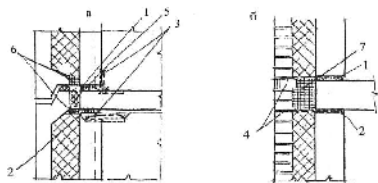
Схемы связей несущих наружных стен с несущими внутренними конструкциями и теплоизоляция зон сопряжений слоистых наружных стен с внутренними несущими конструкциями: а – в панельных стенах; б – в комбинированных (монолитно – кирпичных). 1 – цементный раствор; 2 – упругая прокладка; 3 – сварные стальные связи; 4 – арматурные связи; 5 – утепляющий вкладыш; 6 – "окантовка" торцов панелей негорючим утеплителем; 7 – вкладыш из негорючего утеплителя
